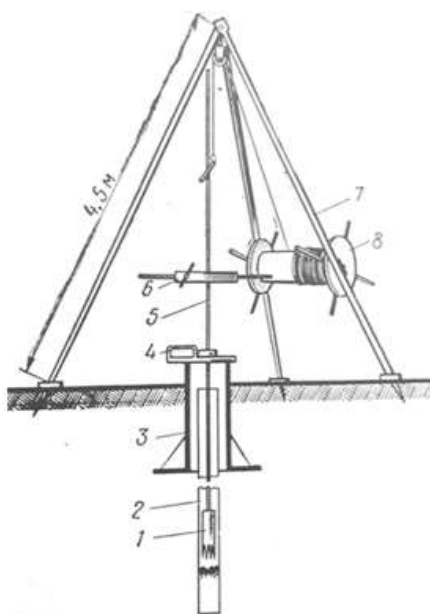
Установка для очистки пьезометров: 1 – буровой снаряд; 2 – труба пьезометра; 3 – труба-люк; 4 – центровочная вилка; 5 – штанга; 6 – хомут-вороток; 7 – копер из труб; 8 - лебёдка
